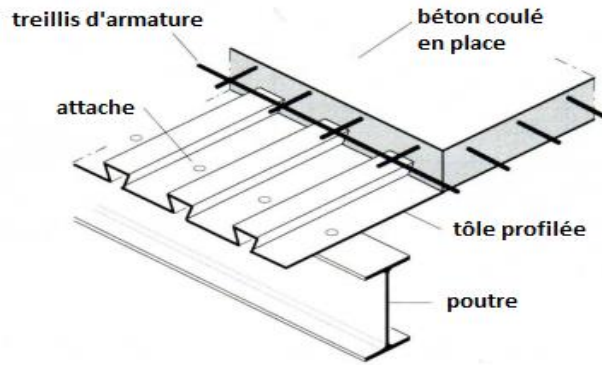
Dalle mixte avec tôle profilée [7].
